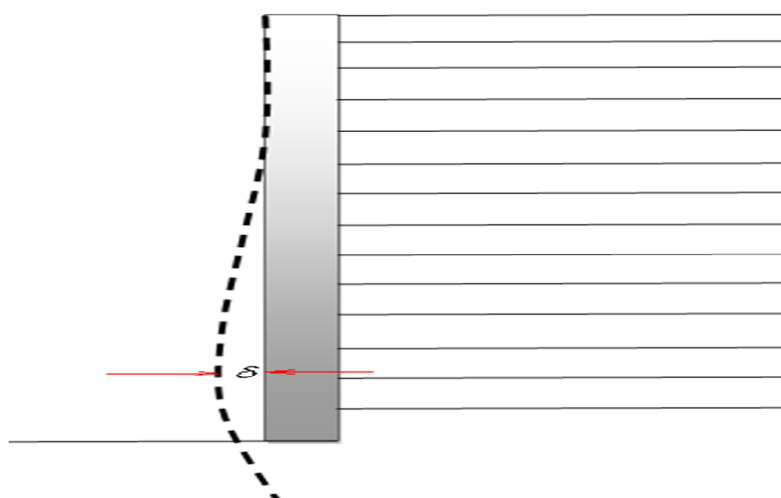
Deslocamento horizontal máximo em estruturas de terra armada (Springer, 2001).
